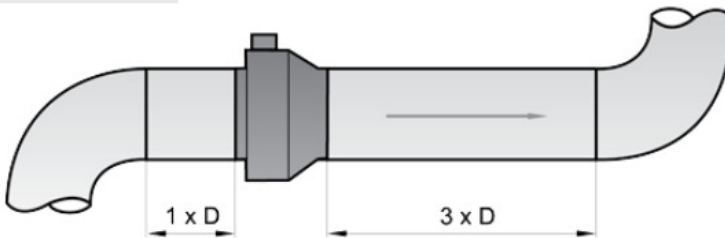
Мінімальні рекомендовані довжини прямих ділянок повітропроводу до і після вентилятора
